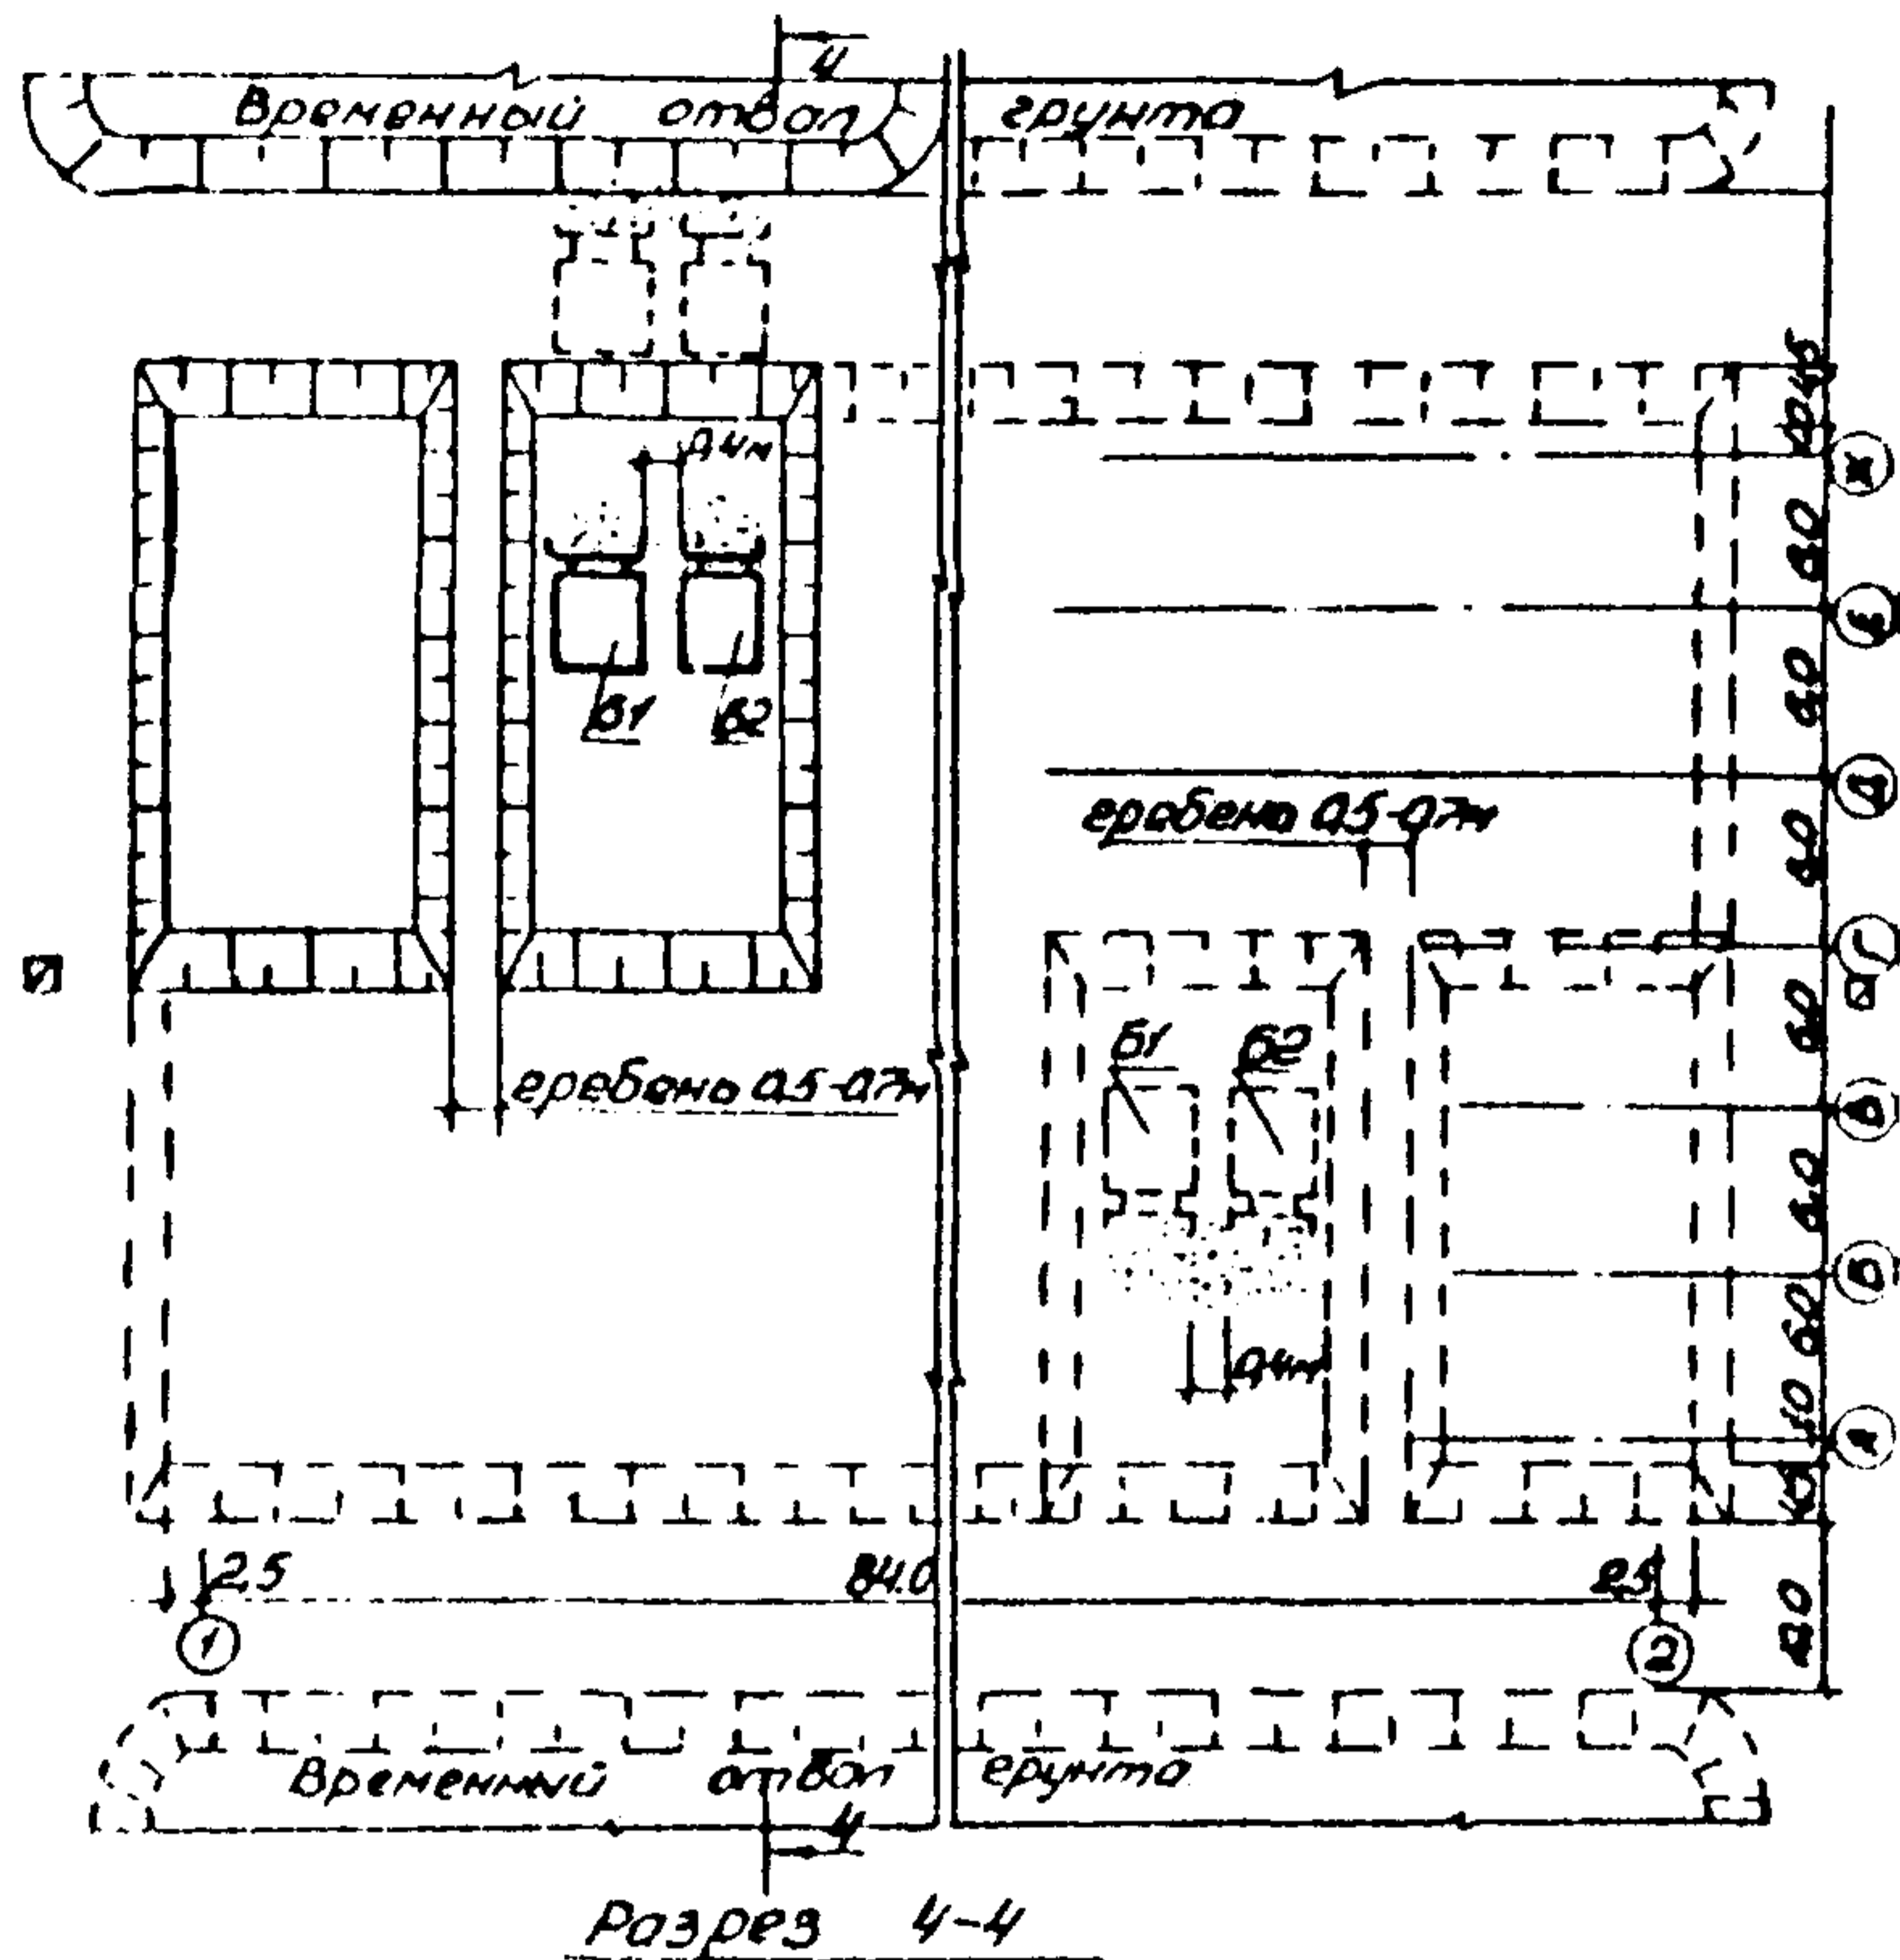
Схема разработки и перемещения грунта траншейным способом:
